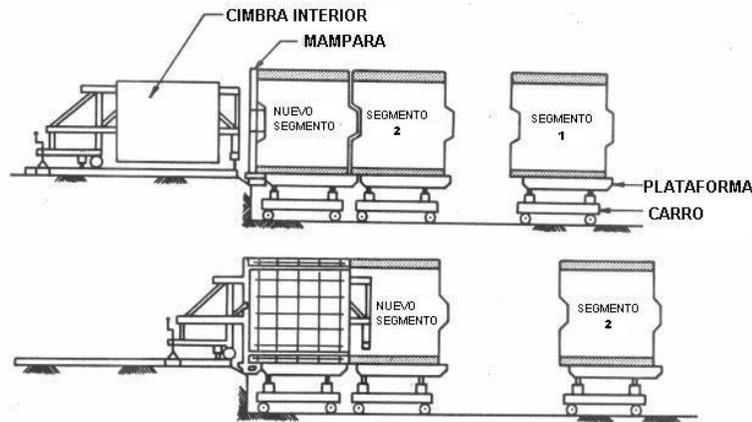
Línea corta de fabricación de elementos para puentes.
